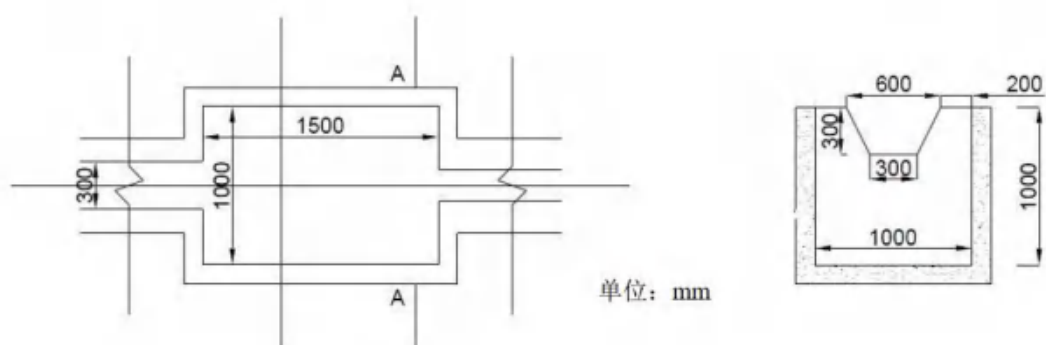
沉沙池平面图及 A-A 剖面图
